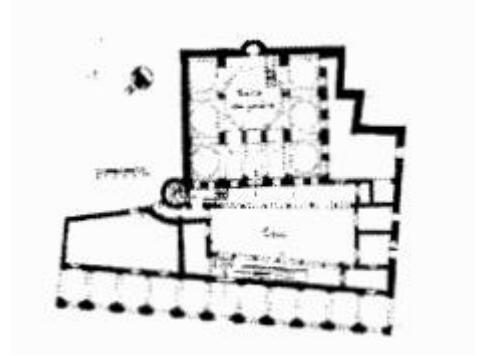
مسقط أفقي لجامع عين البيضاء بمعسكر عن:
